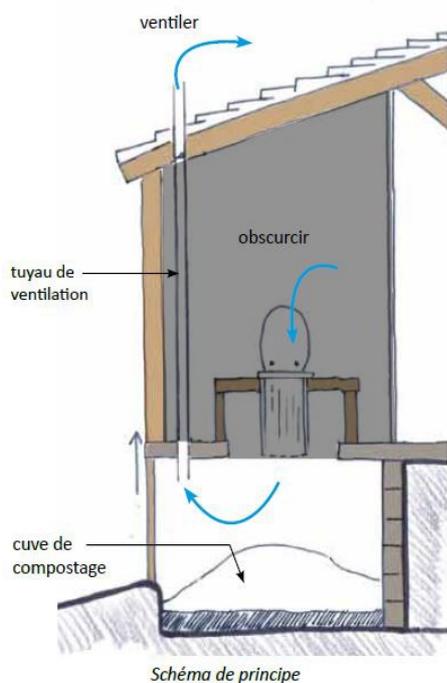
Schéma de principe du système de toilette sèche gravitaire. Par l'équipe de Pierre & Terre.
